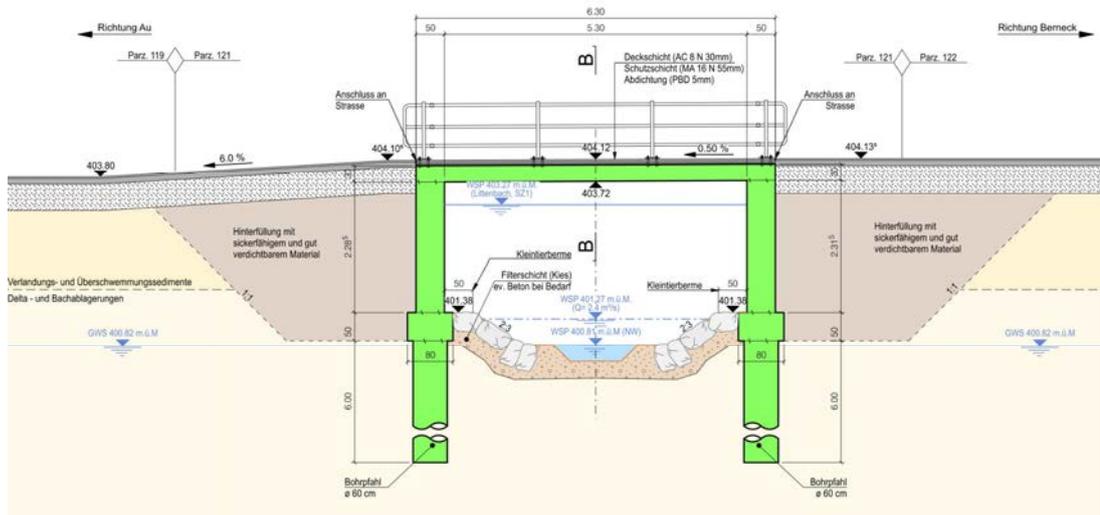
Vertikale Linienführung Brücke Littenbachweg, Kübach
